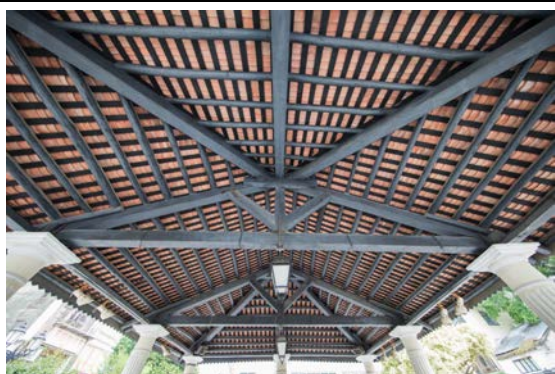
Estrutura de madeira da cobertura do pavilhão
